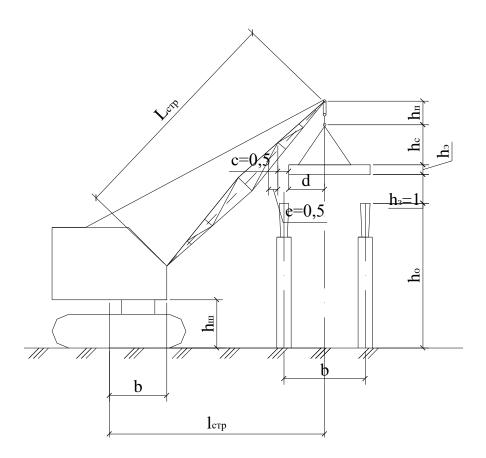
Схема определения монтажного вылета стрелы для плит покрытия
